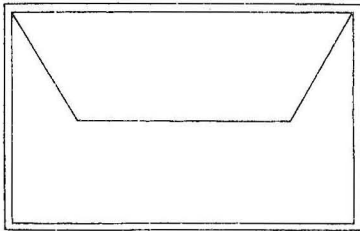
Fenêtre à vantail sur axe horizontal supérieur (ouvrante vers l'extérieur)
